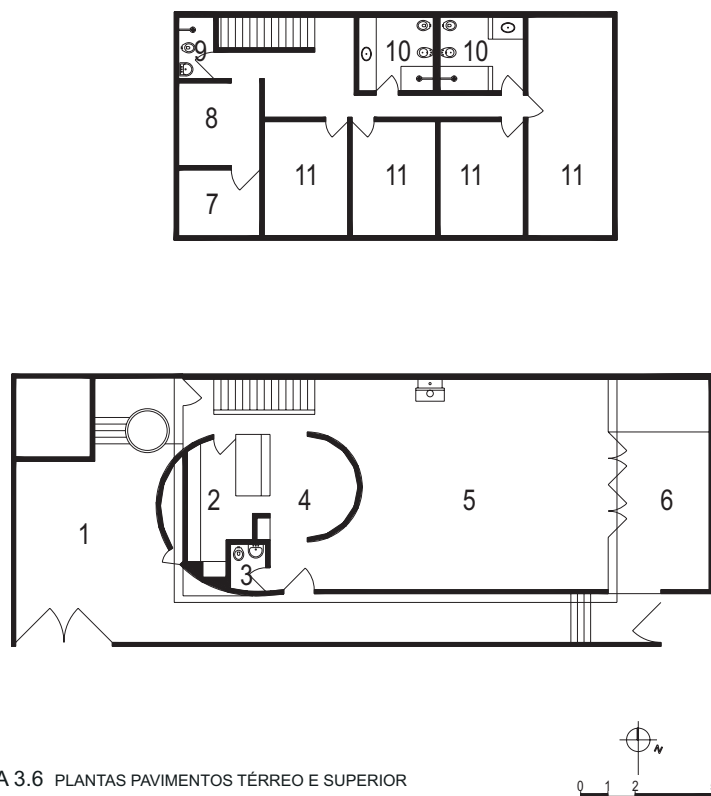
PLANTAS PAVIMENTOS TÉRREO E SUPERIOR
